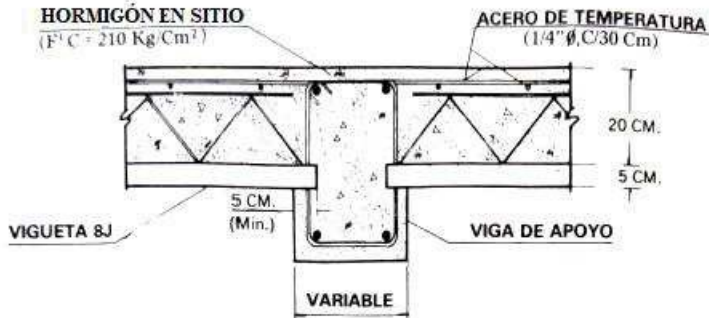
APOYO DE VIGUETA EN VIGA PRINCIPAL
